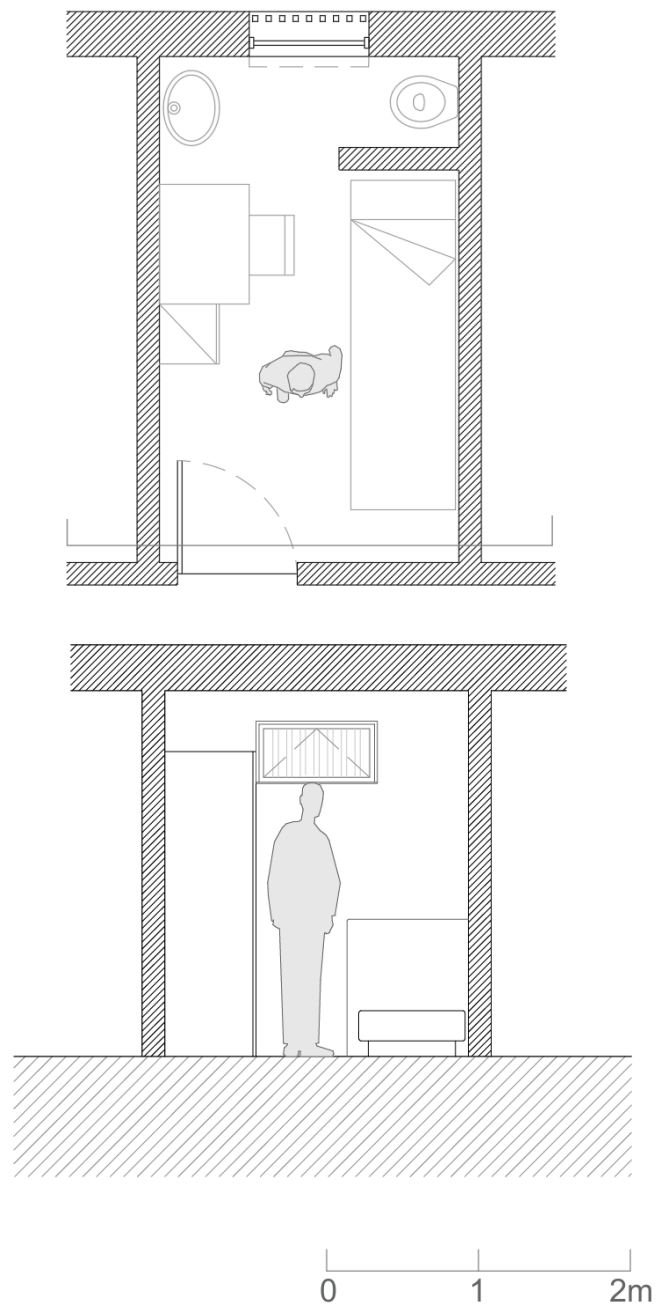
Planta e corte de uma cela standard em Portugal (esc:1:50)
